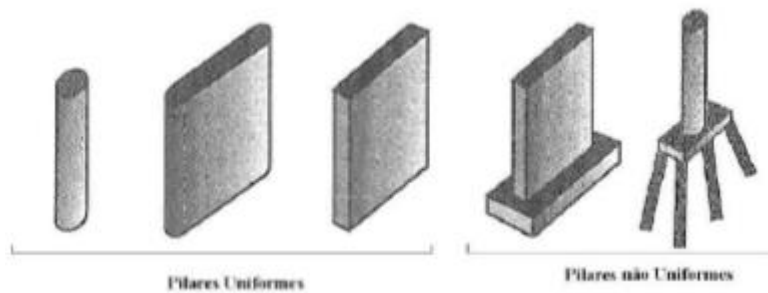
Tipos de pilares (adaptada de Melville e Coleman, 2000)
